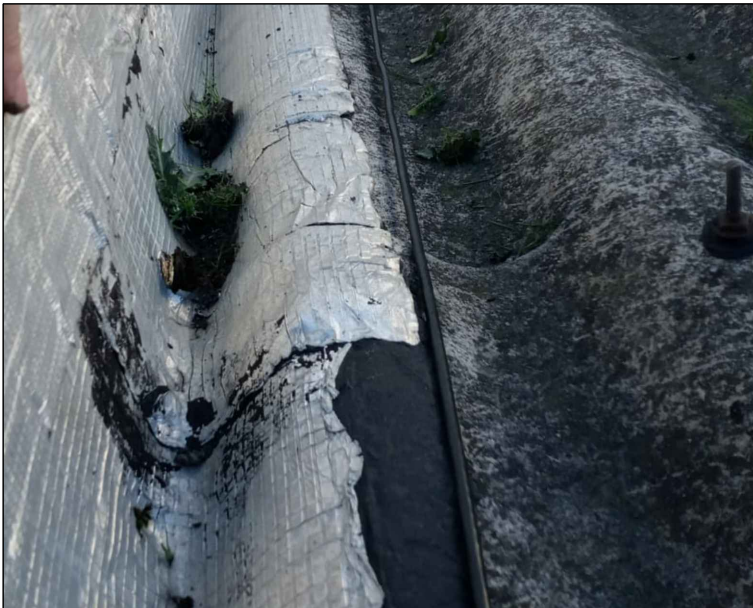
CUBIERTA ALA 2 SOBRE LABORATORIOS
